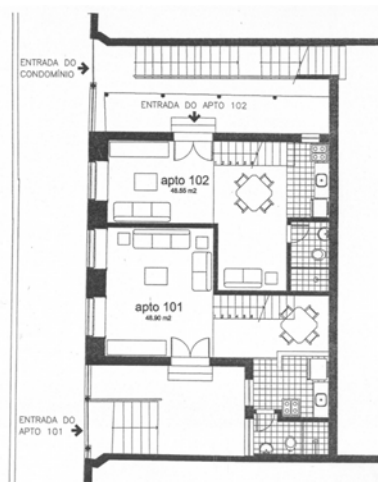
Rua Francisco Muratori, 38 – Planta baixa primeiro pavimento (FREIRE, 1999, p. 3).
